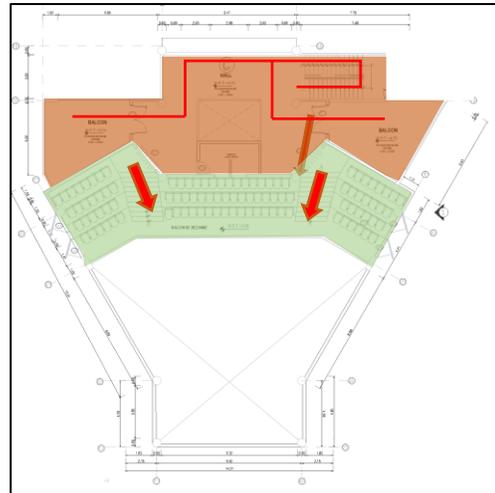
PLANTA DE DISTRIBUCIÓN AUDITORIO – PRIMER NIVEL
